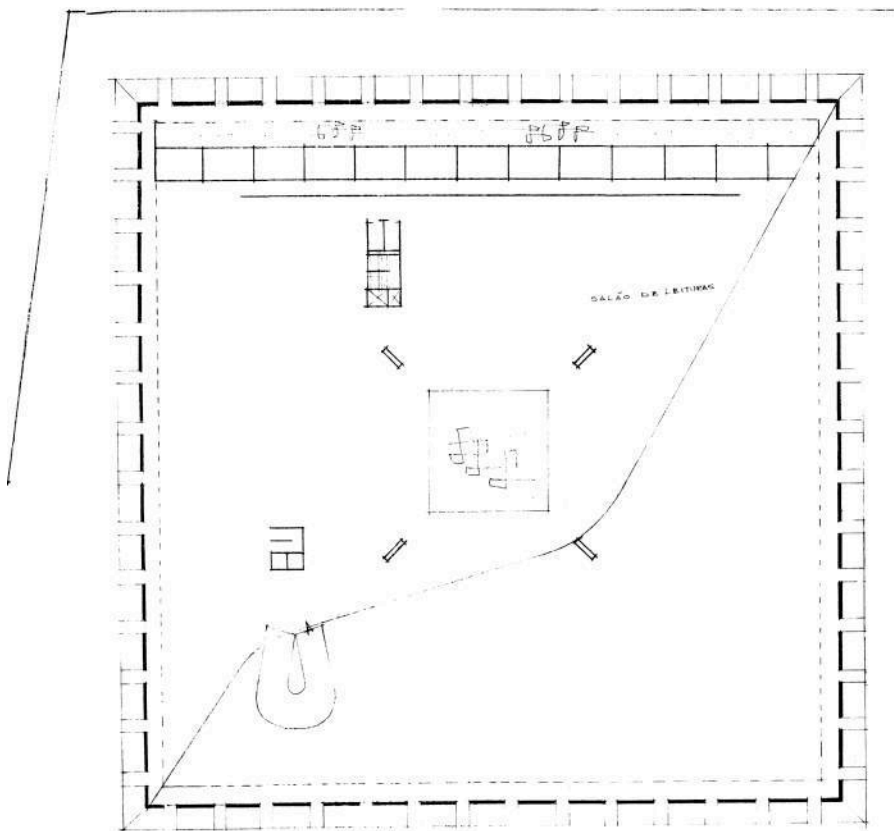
BNB, planta baixa – sobreloja, 1969. Fonte: ArqPDF..
